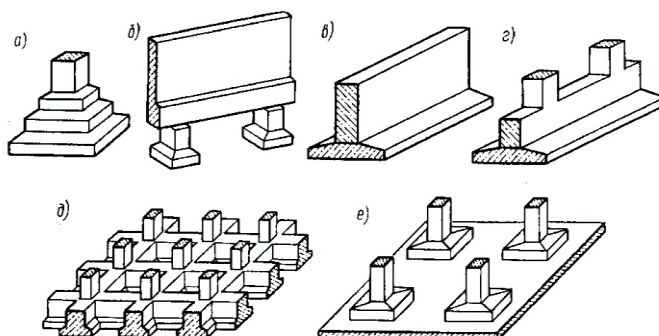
Основные типы фундаментов мелкого заложения: а – отдельный фундамент под колонну; б – отдельные фундаменты под стену; в – ленточный фундамент под стену; г – ленточный фундамент под колонны; д – ленточный фундамент, под сетку колонн; е – плитный фундамент
